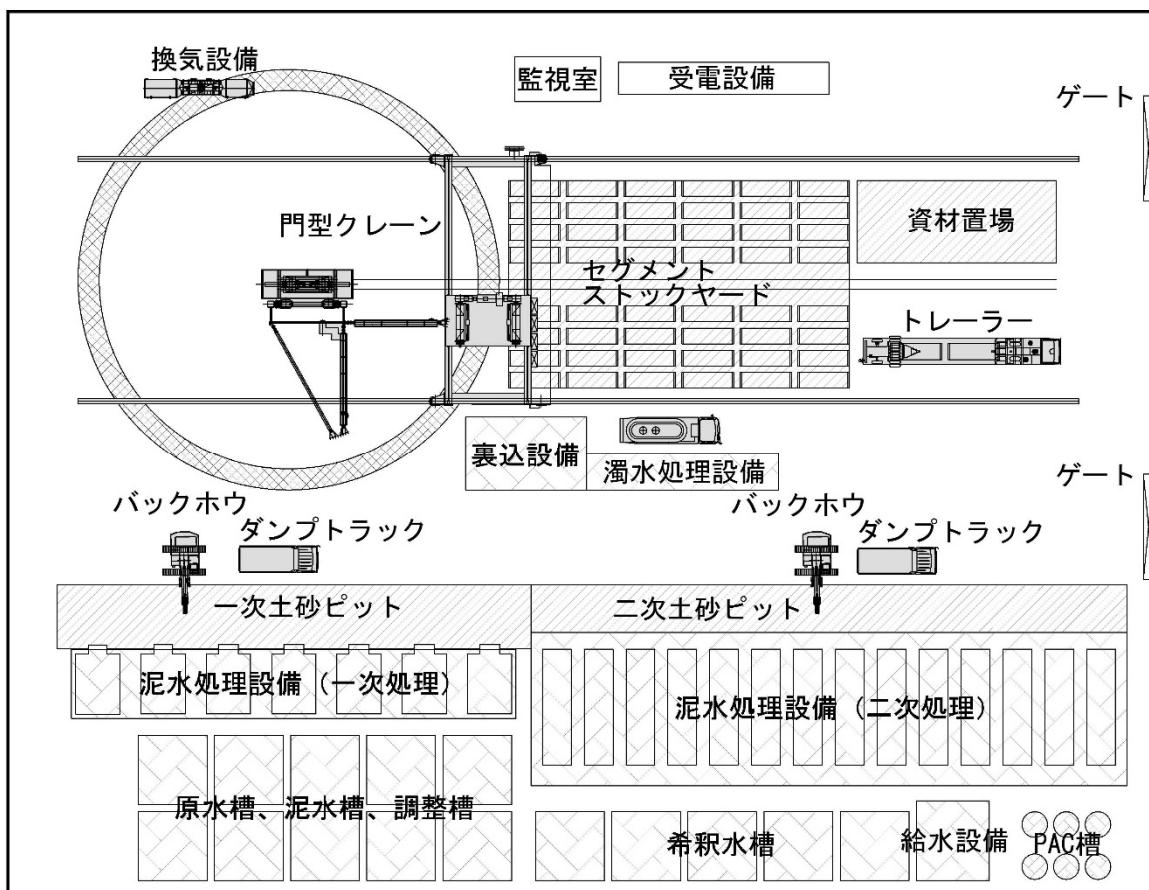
非常口の施工ヤードの概要（泥水式シールド工法によるトンネル施工時）
